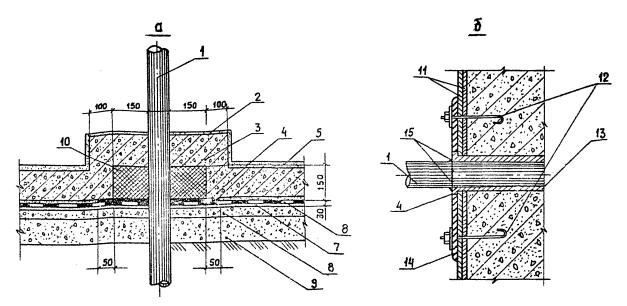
Герметизация узлов пропуска существующих трубопроводов а — через полы, б — через стены:
